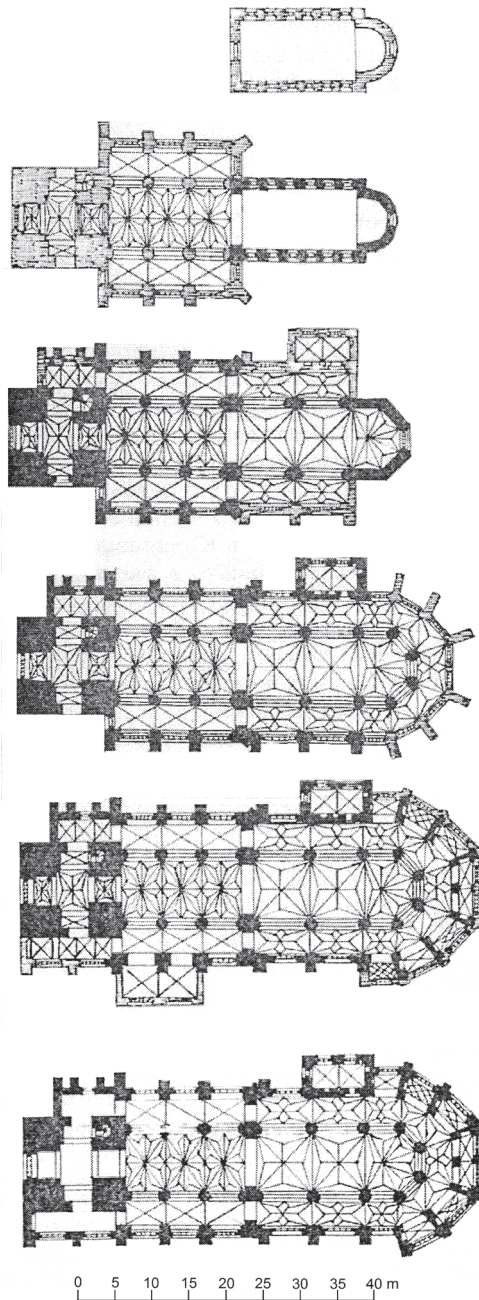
Stargard St. Johannis, Grundrisse der einzelnen Bauphasen
